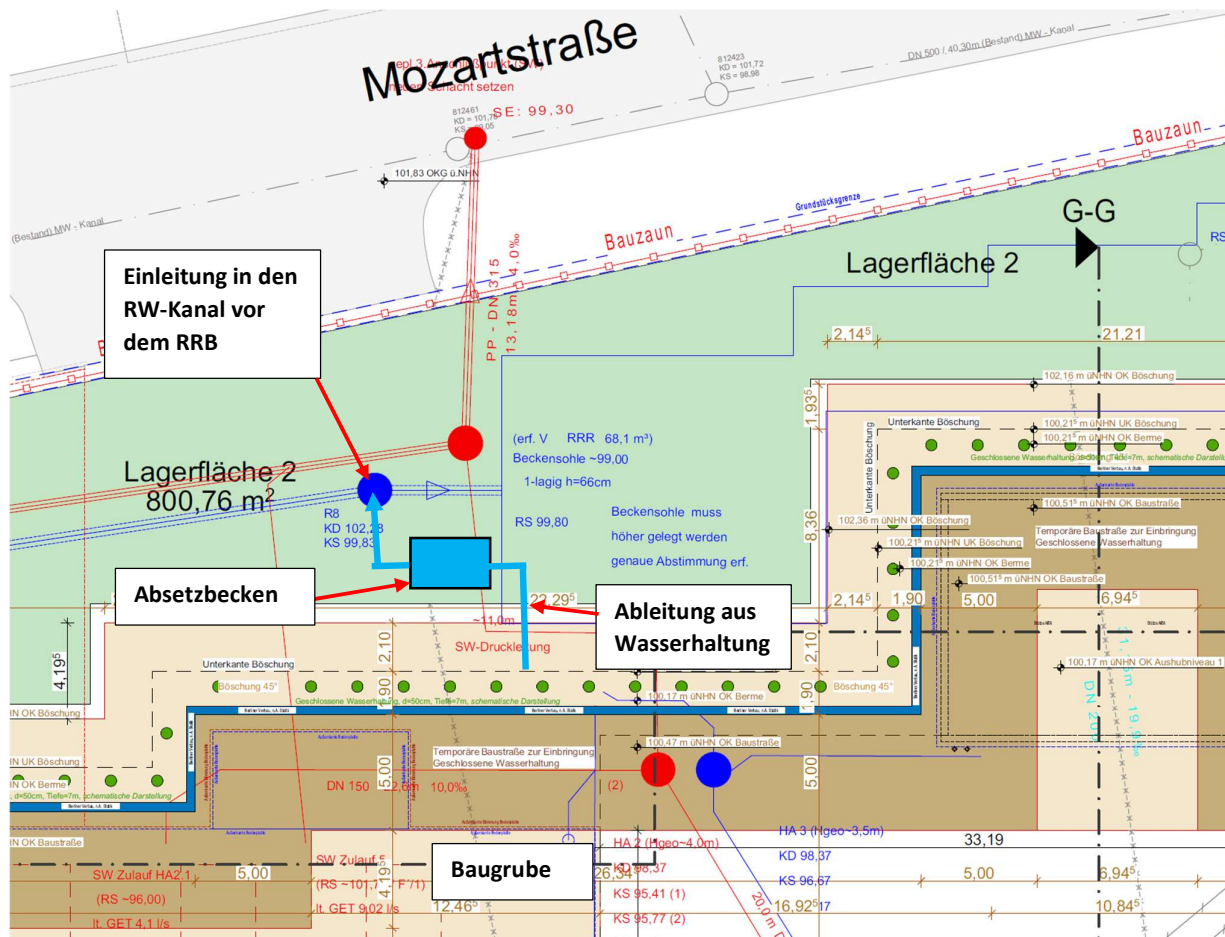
Lageplan Baustelle mit Ableitung in den Vorfluter, Quelle: [U2]
